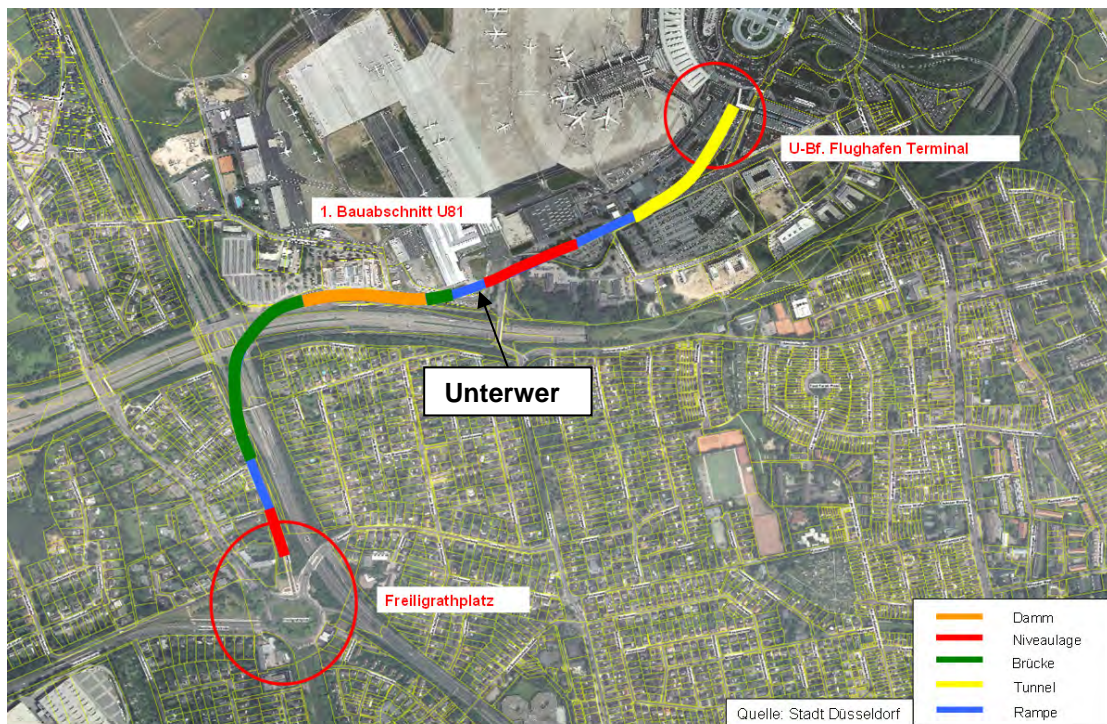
Lageplan mit Übersicht der Streckenabschnitte (Quelle: Stadt Düsseldorf)
